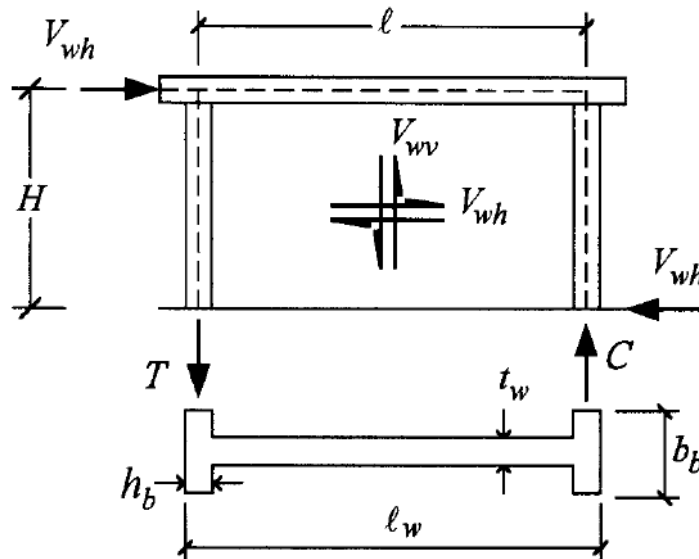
Acciones internas y externas de muros cortos de hormigón armado (Hwang et al. (2001))
